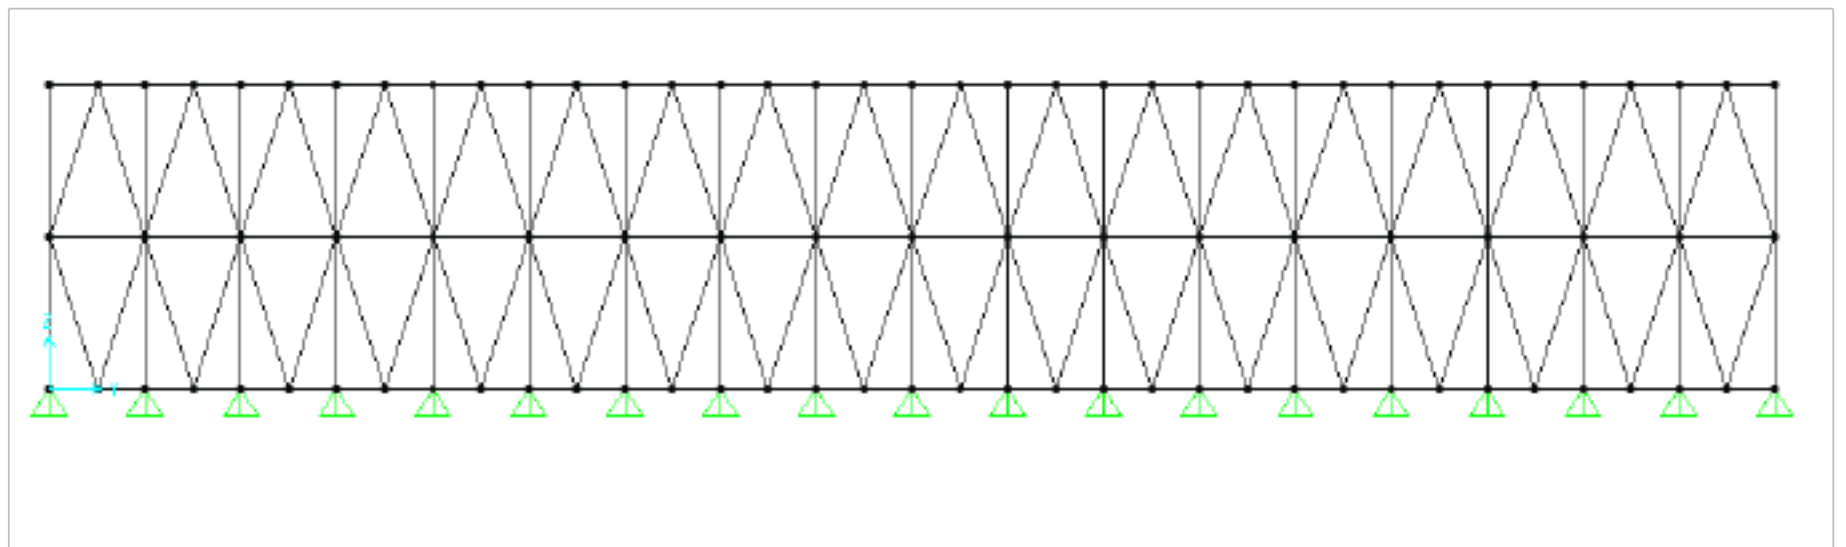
临时贝雷梁桥有限元计算模型横断面图
